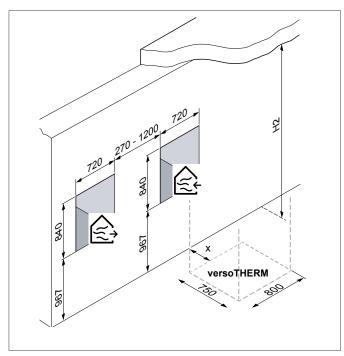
Installazione parallelamente alla parete, ingresso aria a sinistra
